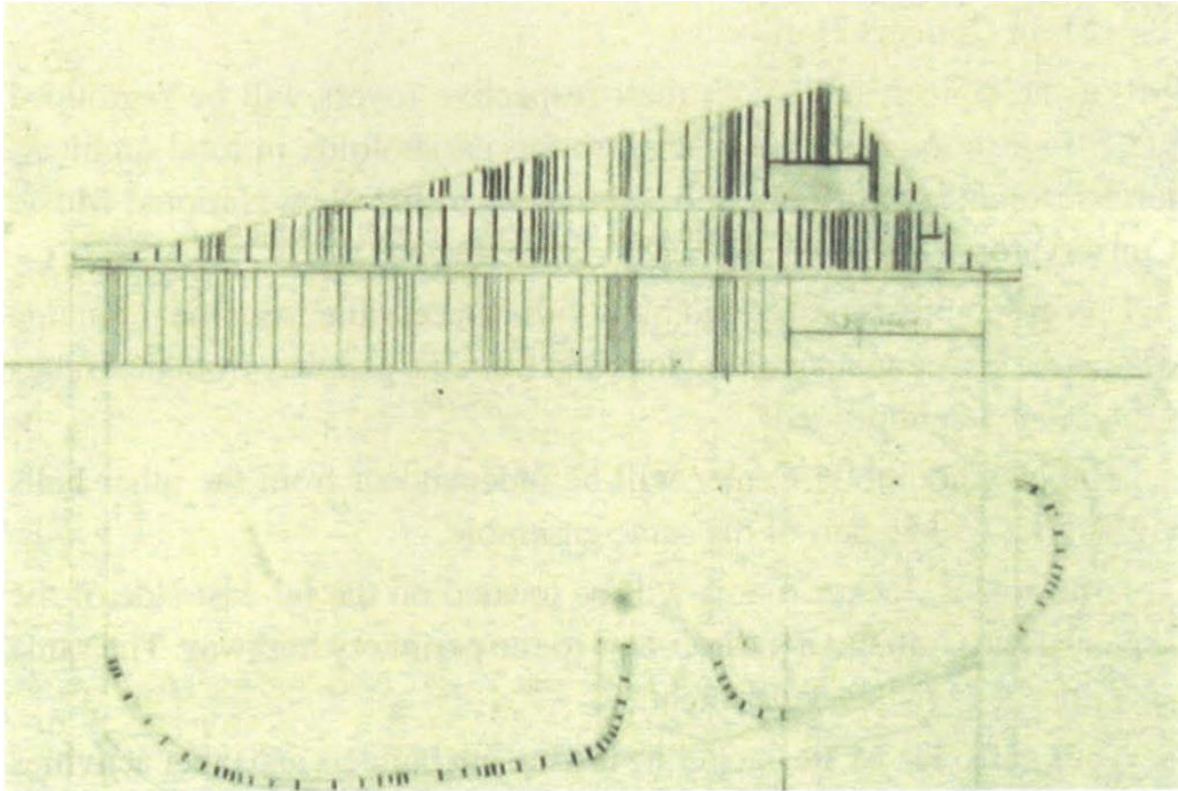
Plan de l'entrée de la Cité de la Musique
